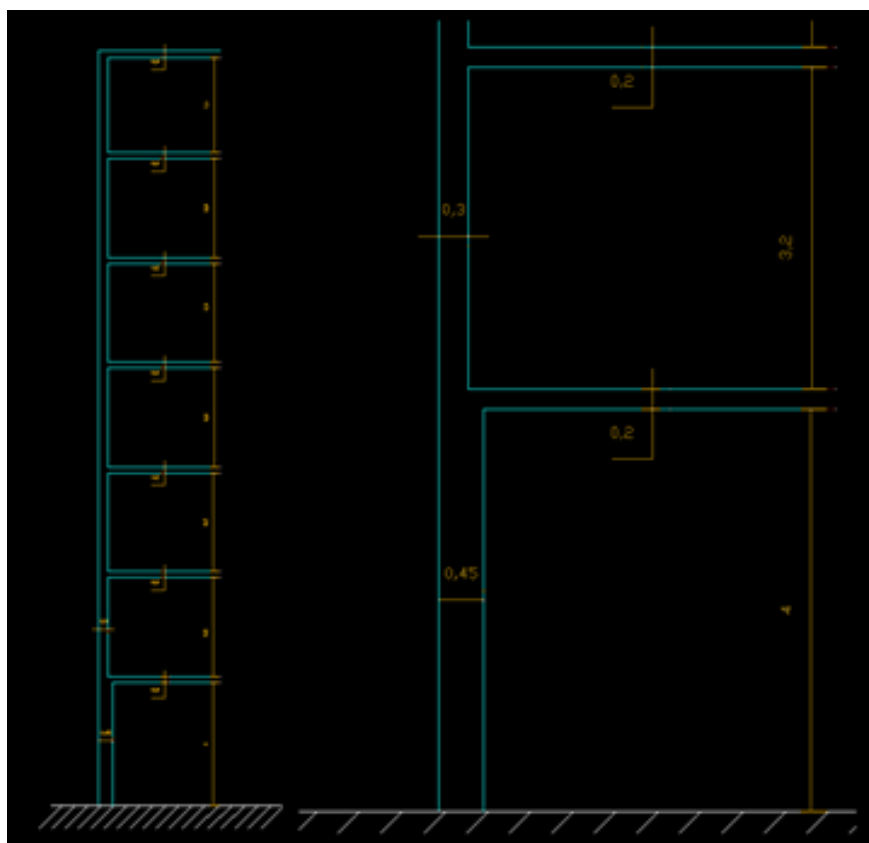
10 Plano general de las alturas del edificio (Izquierda); Detalle de las alturas de la PB y la planta tipo (Derecha)
